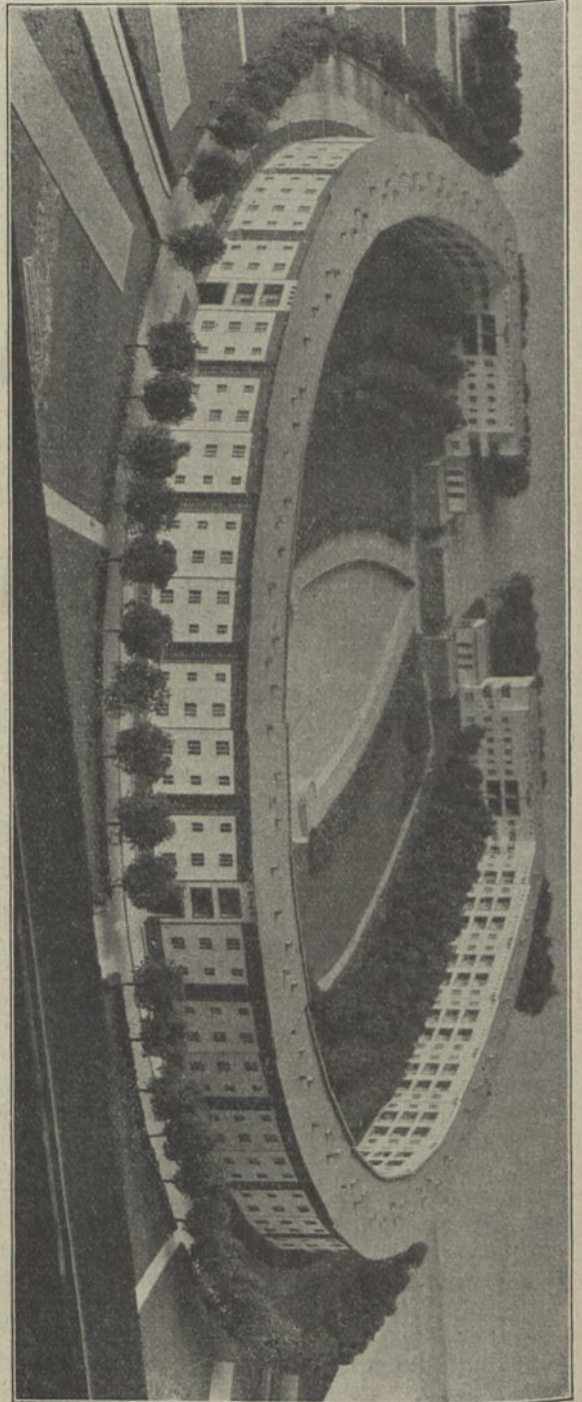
Modellansicht vom Südfuß in der Großriedlung Strß. Verfasser: Arch. Bruno Taut, Stadtbaurat a. D.
